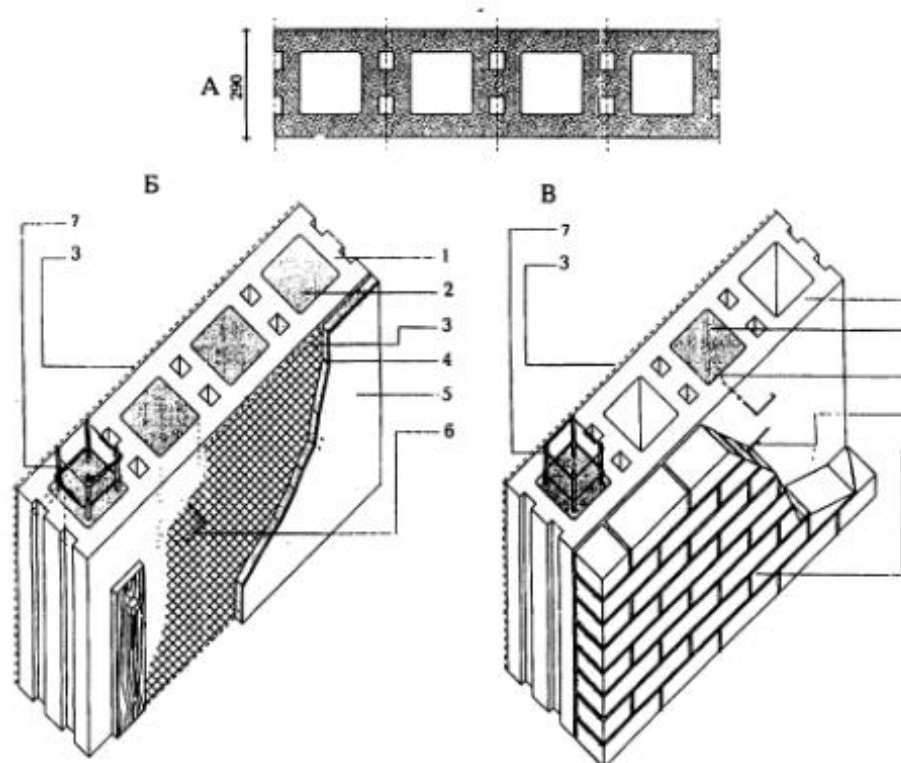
Наружные стены "Пластбау": А - стеновой пенополистирольный элемент опалубки; Б - наружная стена с мокрой штукатуркой; В - то же, с наружной кирпичной облицовкой; 1 - стеновой элемент опалубки; 2 - монолитный бетон; 3 - сетка Рабитц; 4 - штукатурка (мелкозернистый бетон); 5 - краска; 6 - анкер для сетки Рабитц; 7 - арматура; 8 - армированные кладки; 9 - облицовочный кирпич
